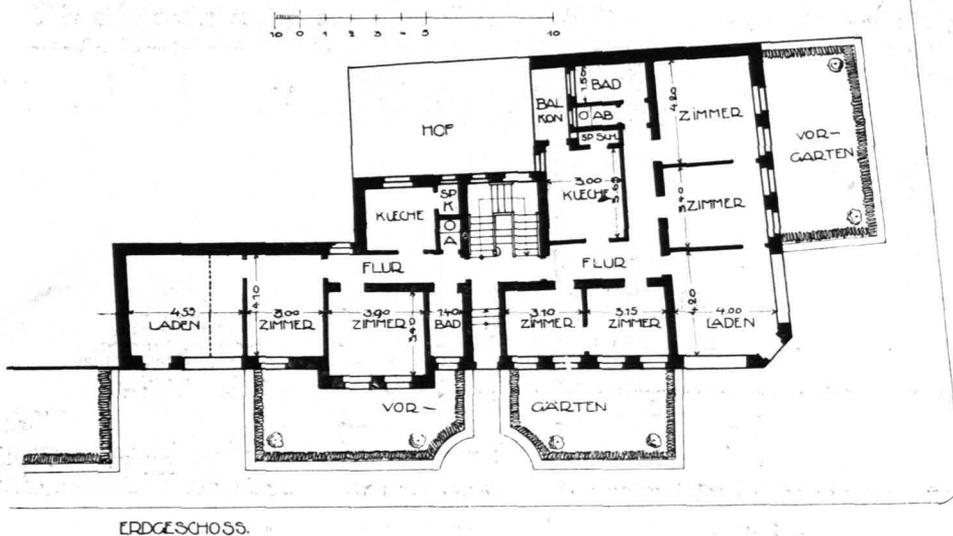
GRUNDRISS. (M. 1:300.)
